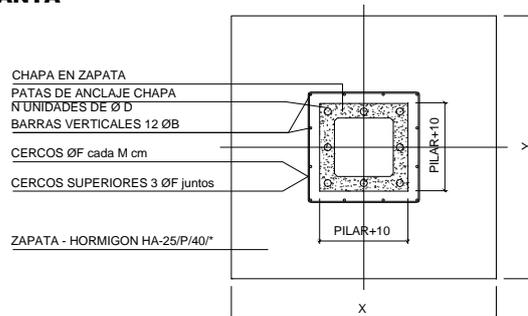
UNIÓN SOLDADA
